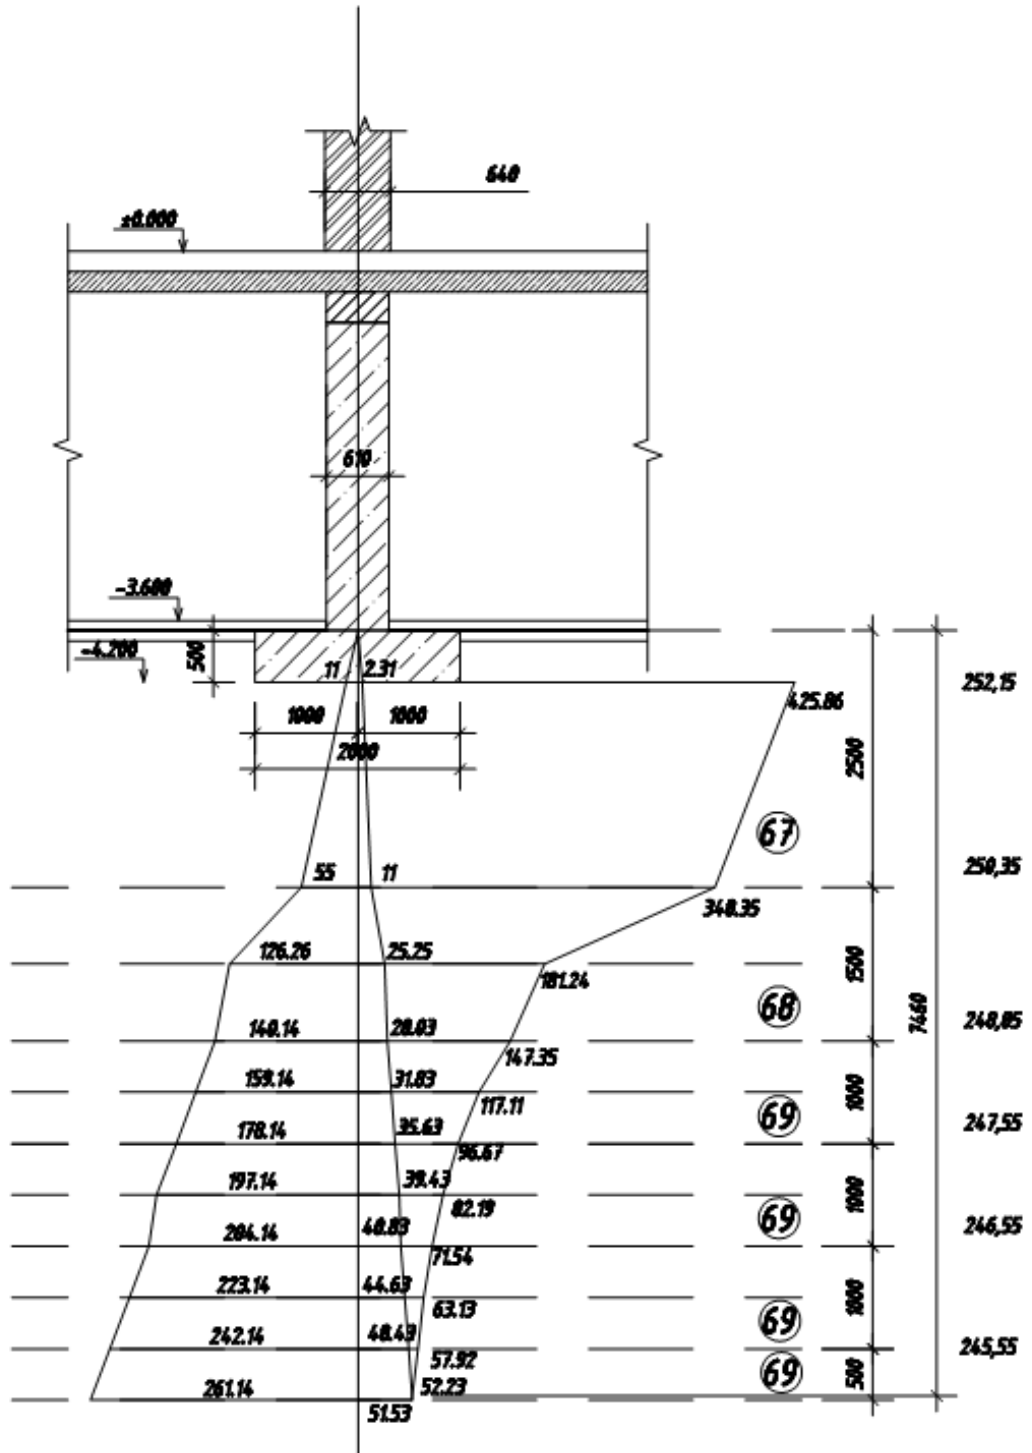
Епюра напружень у фундаменті неглибокого залягання в перерізі 2-2
